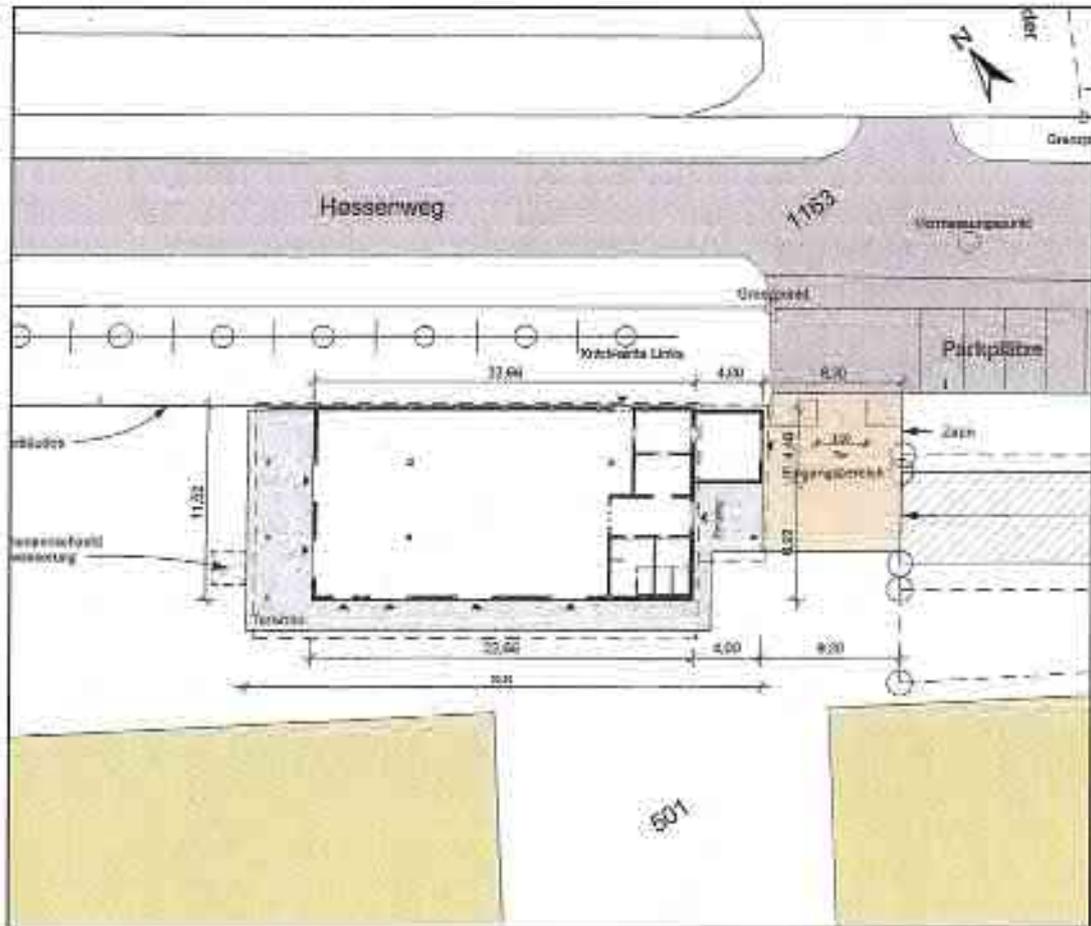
Lageplan zum geplanten Vereinsheim (Entwurf, Ausschnitt) /12/
